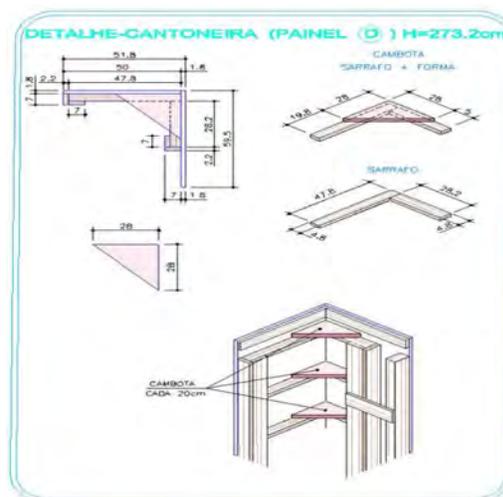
Detalhe cantoneira para painel do pilar – Fonte: Projeto de Fôrmas (ASSAHI ENGENHARIA).
